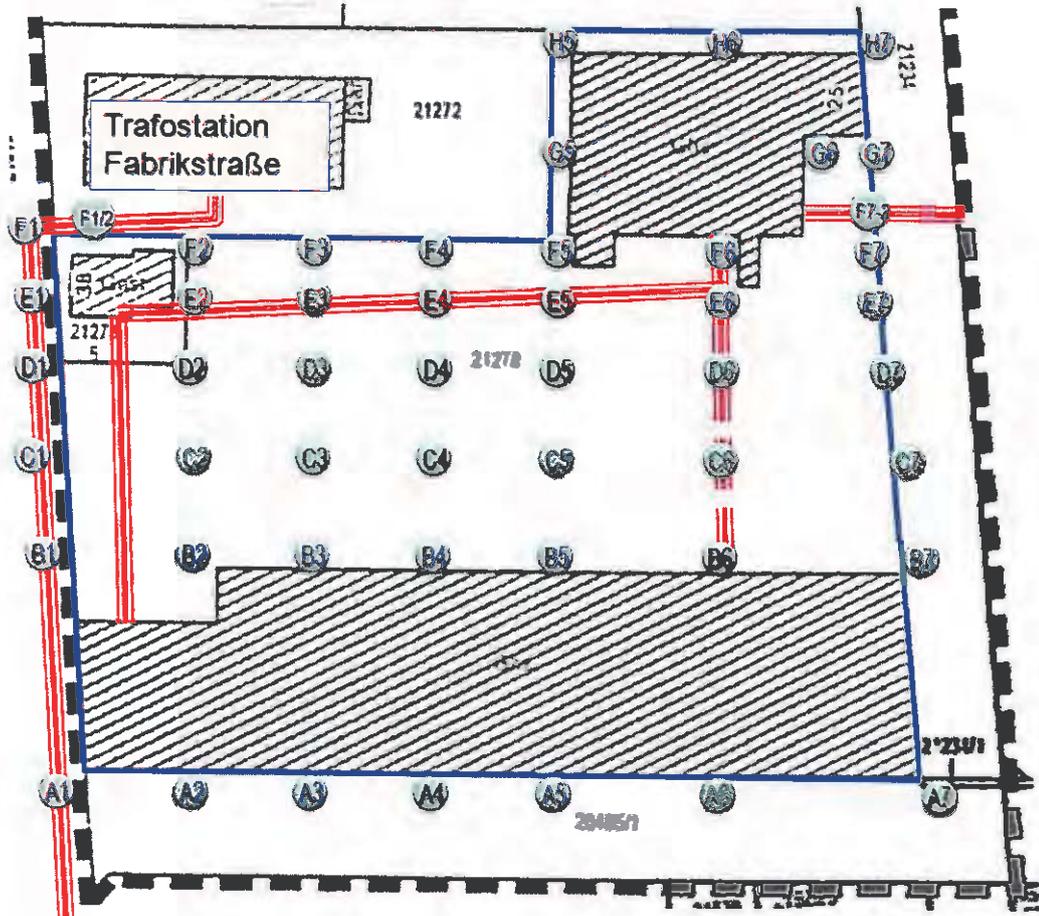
Lage der Messpunkte auf dem Baugrundstück
